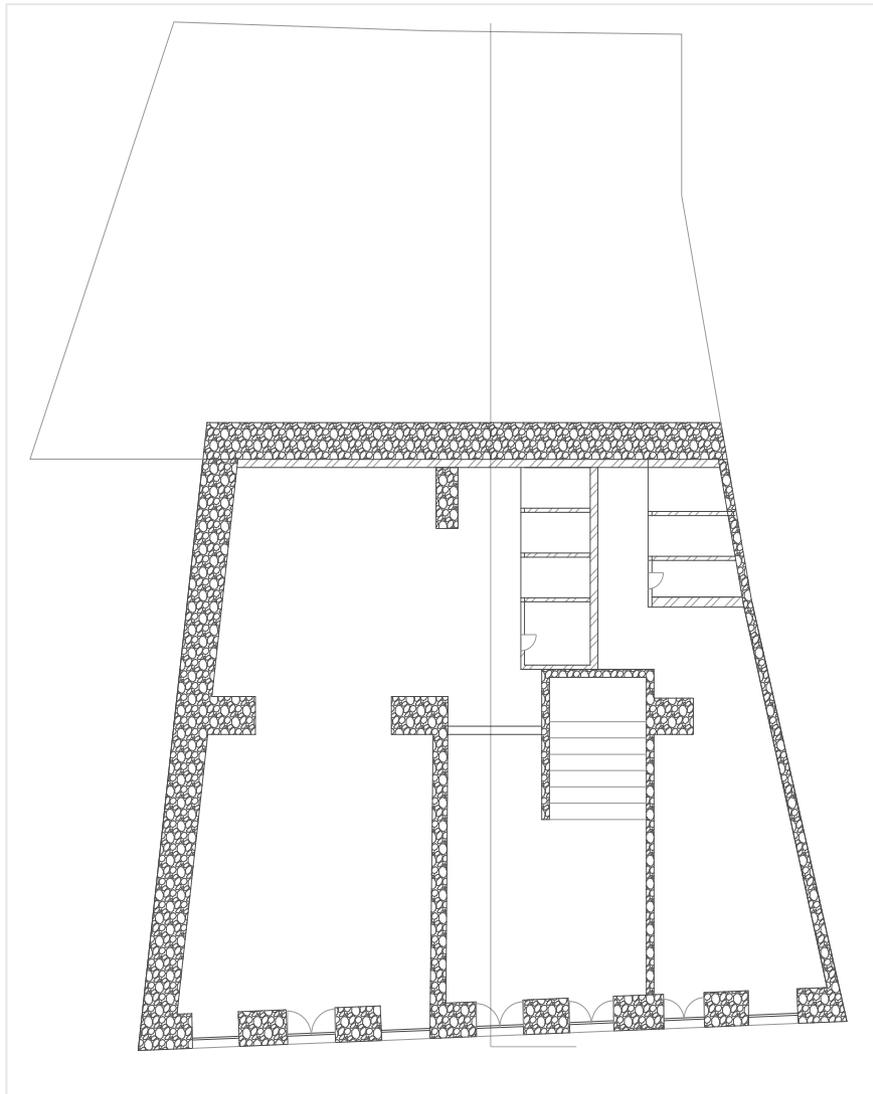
Planta piso 0 proposta alteração. Eliminar a loja central, por meio da demolição da parede central e reconstrução da parede de fundo para que a entrada principal volte, como na sua origem, a ser pela porta central do edifício, criando-se assim um novo.
